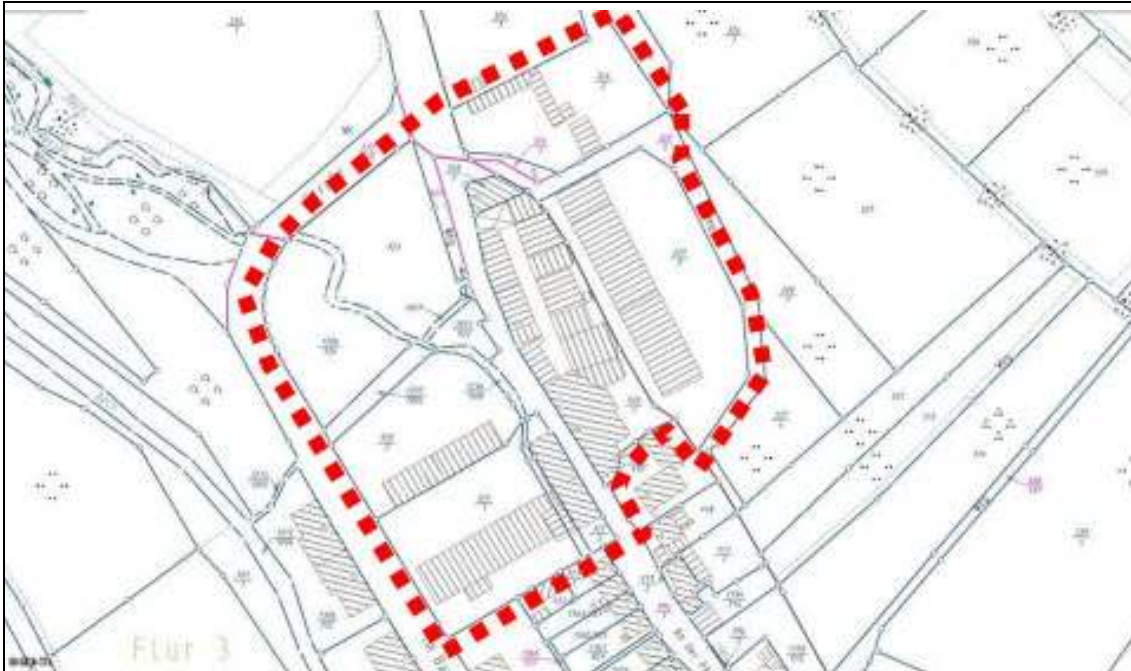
Lageplan Pörz-Brauerei, Rudolstadt
